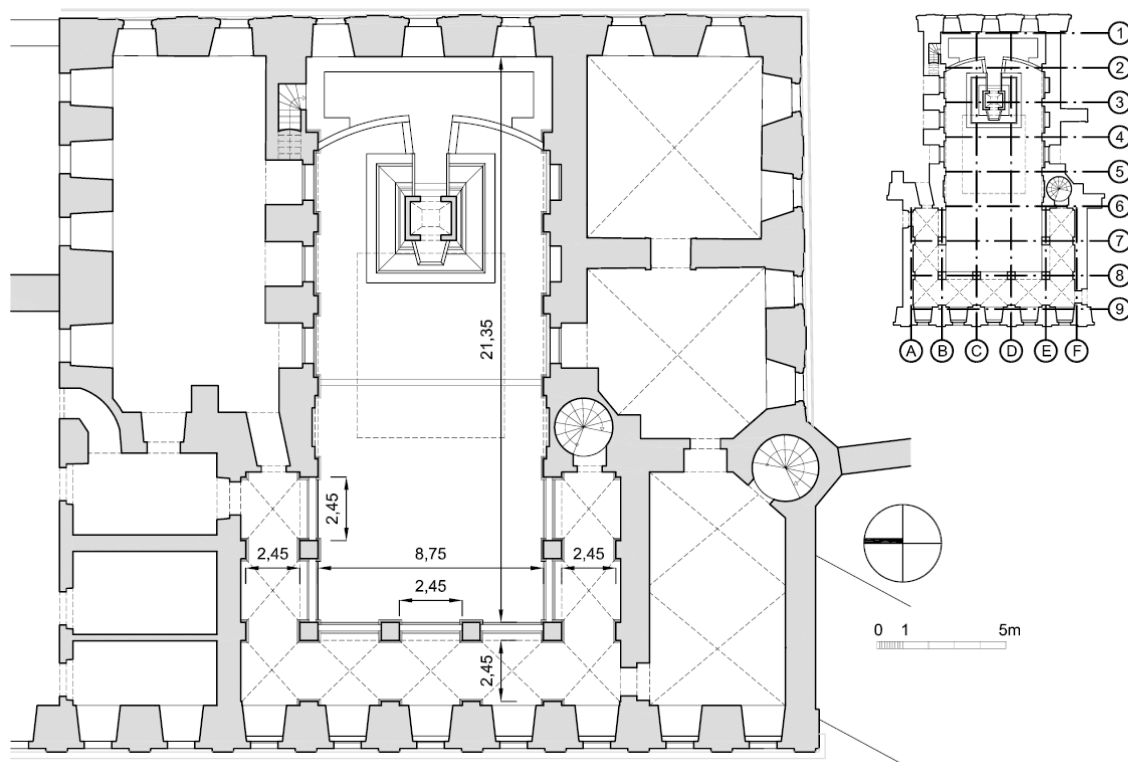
Rekonstruktion, Grundriss 1.Obergeschoss, in Anlehnung an [Sch 04/1]
